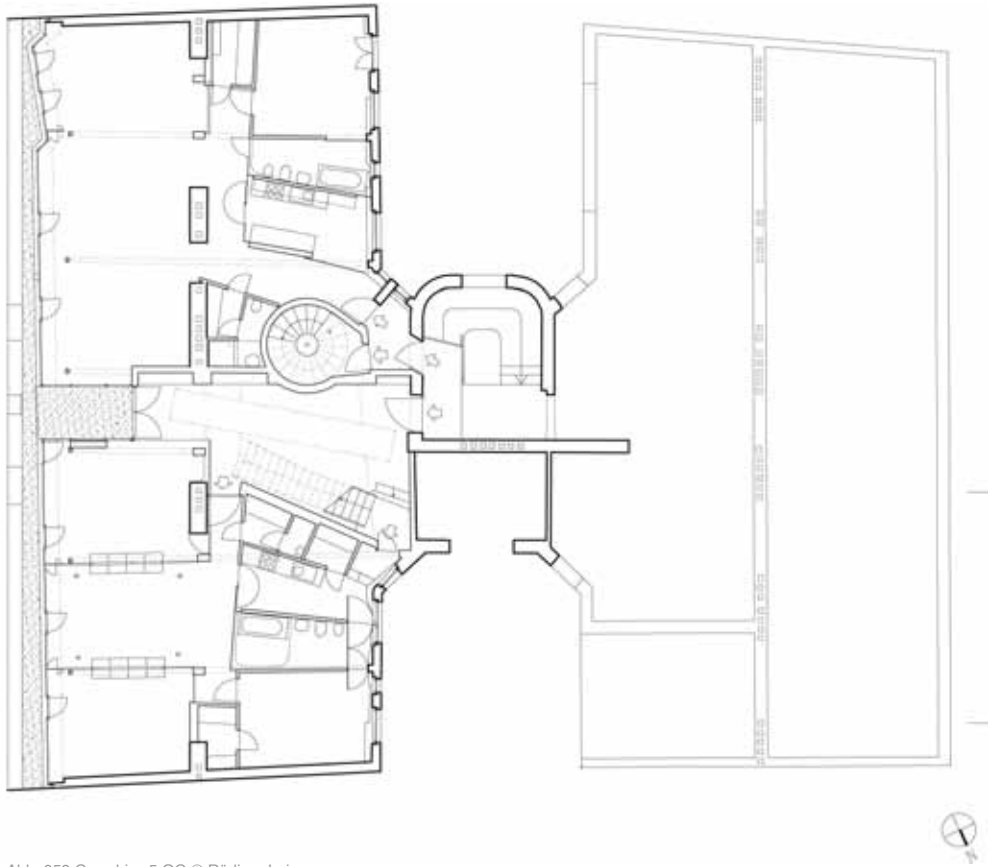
Grundriss 5.OG © Rüdiger Lainer
